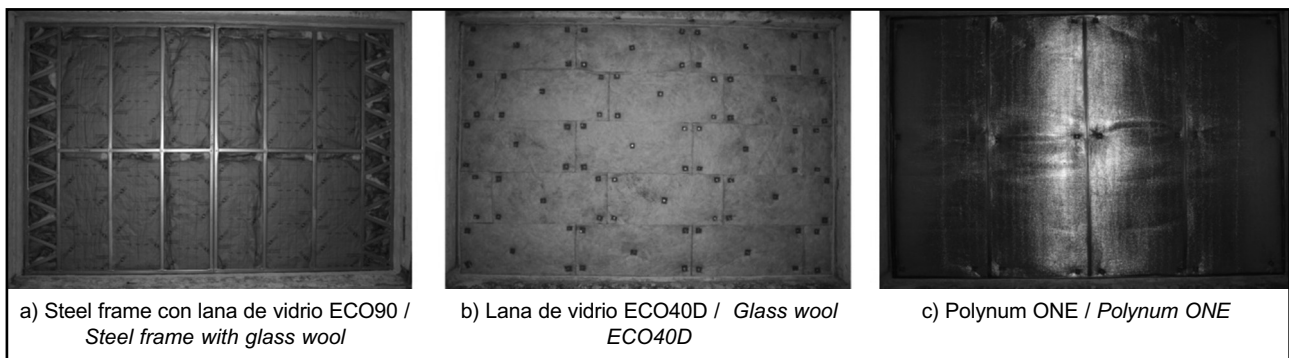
Fotografías del montaje de las fachadas multicapas ligeras en el portamuestras.
